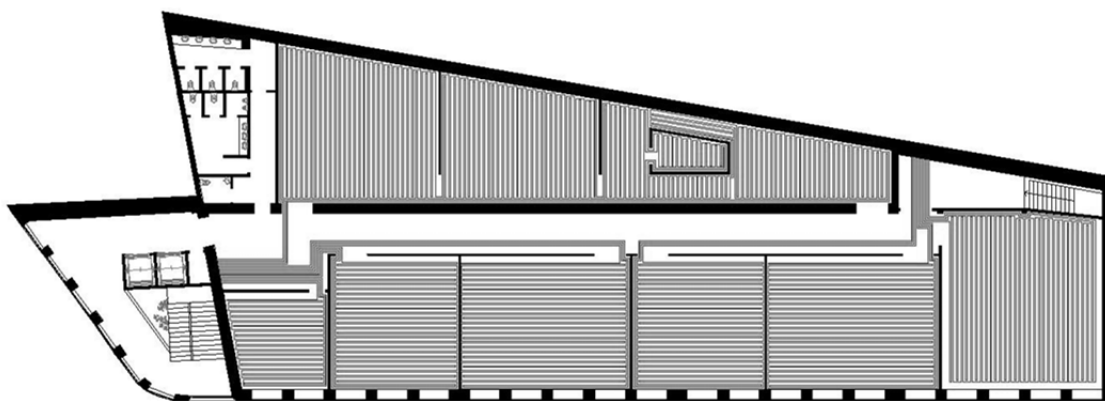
Planta de distribuição do Piso Radiante, Piso 2
